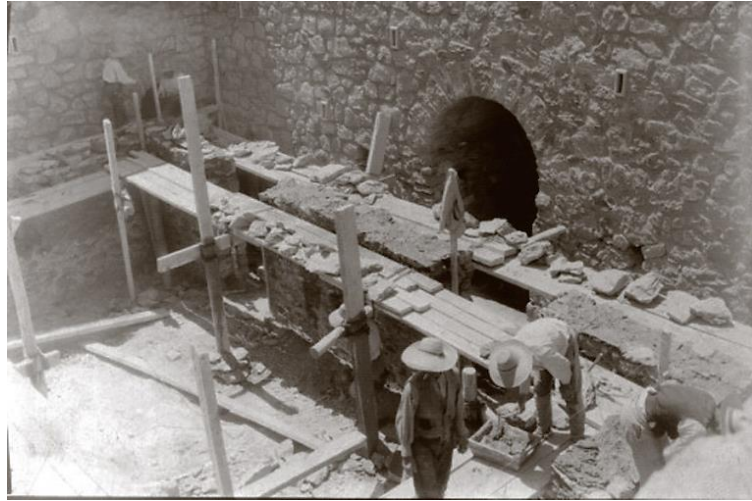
Levantamiento de paramentos con mampostería. (Fuente: Lorenzo, 2019)
